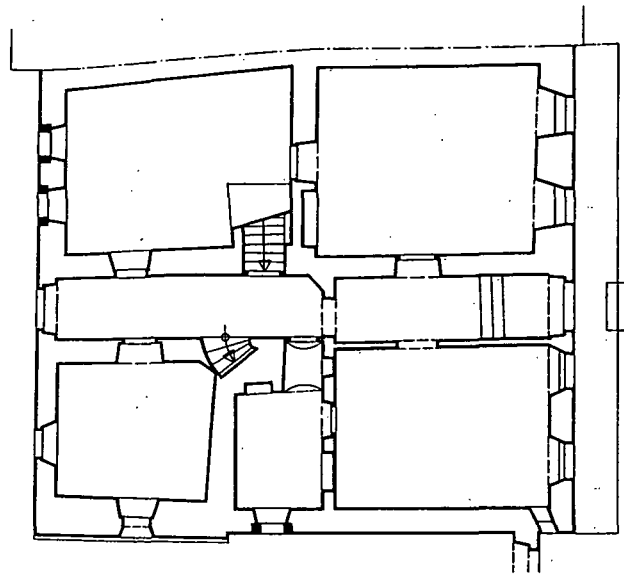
Ledererstraße 18 – Grundrisse Keller, Erdgeschoss (1:200).
